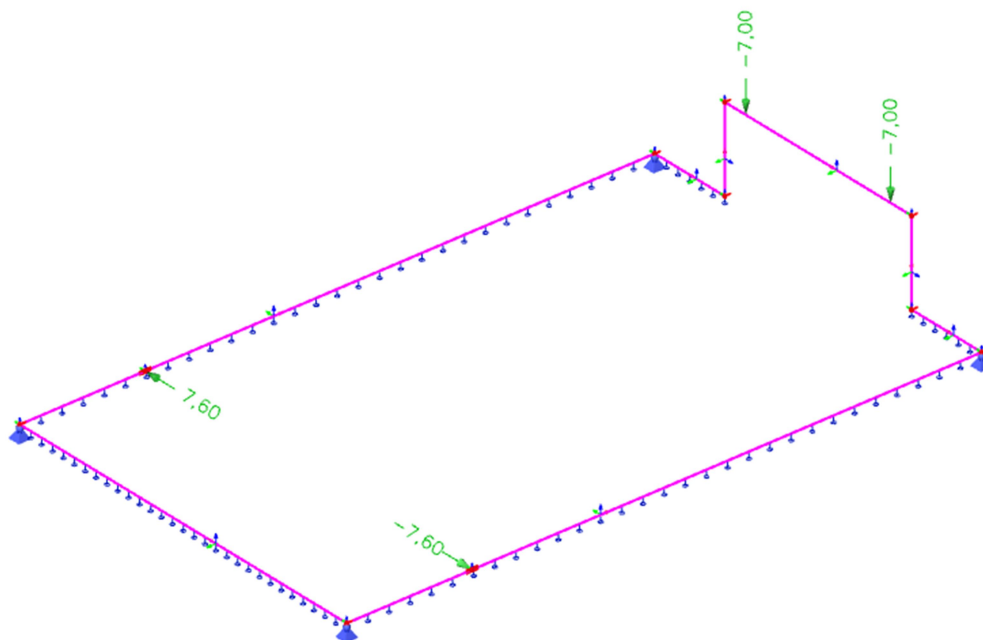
Konstrukce 2, Zatěžovací stav ZS3
